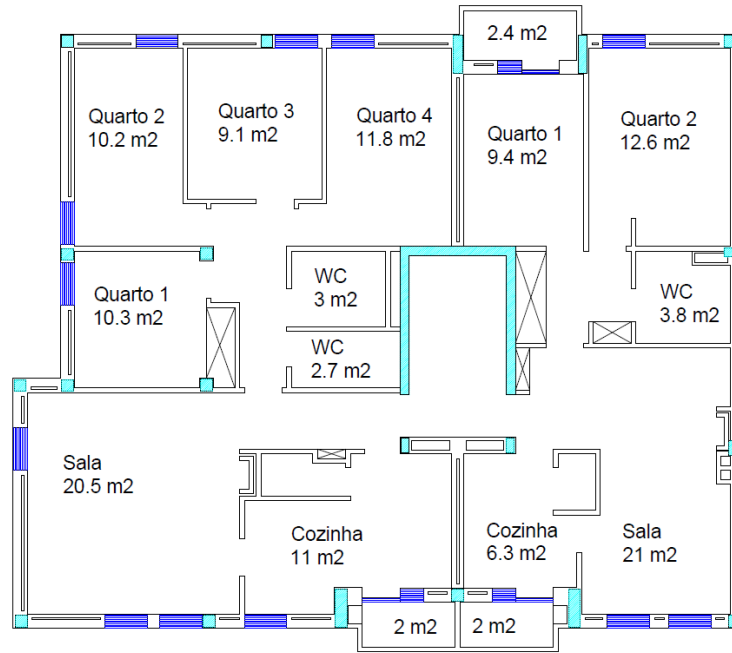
Planta tipo T4-T2 (1º; 2º; 3º)
